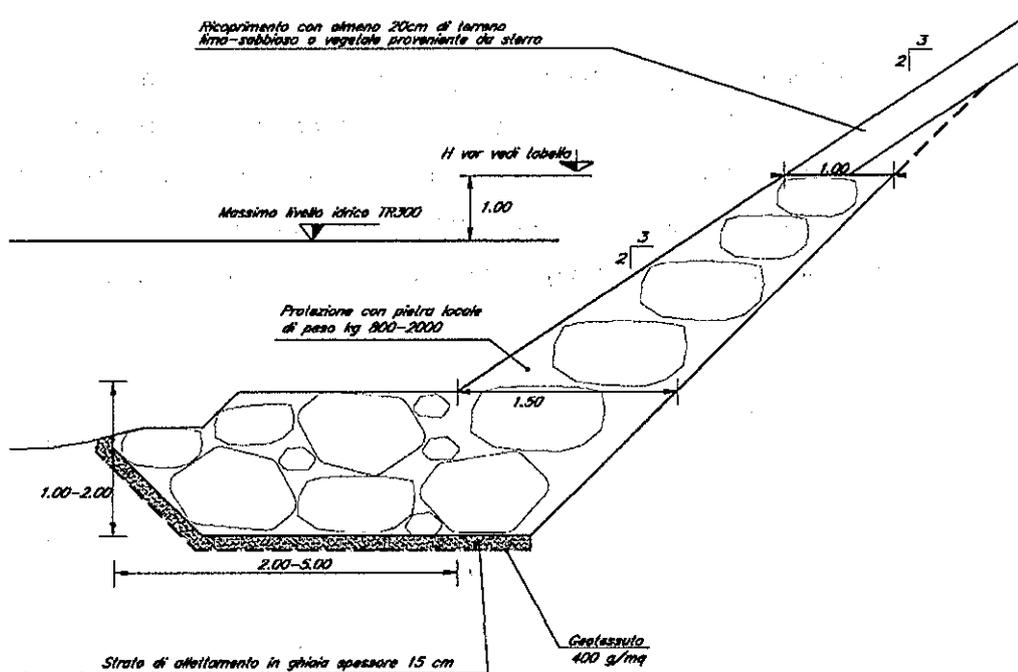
Dettaglio della protezione del rilevato in massi cementati
